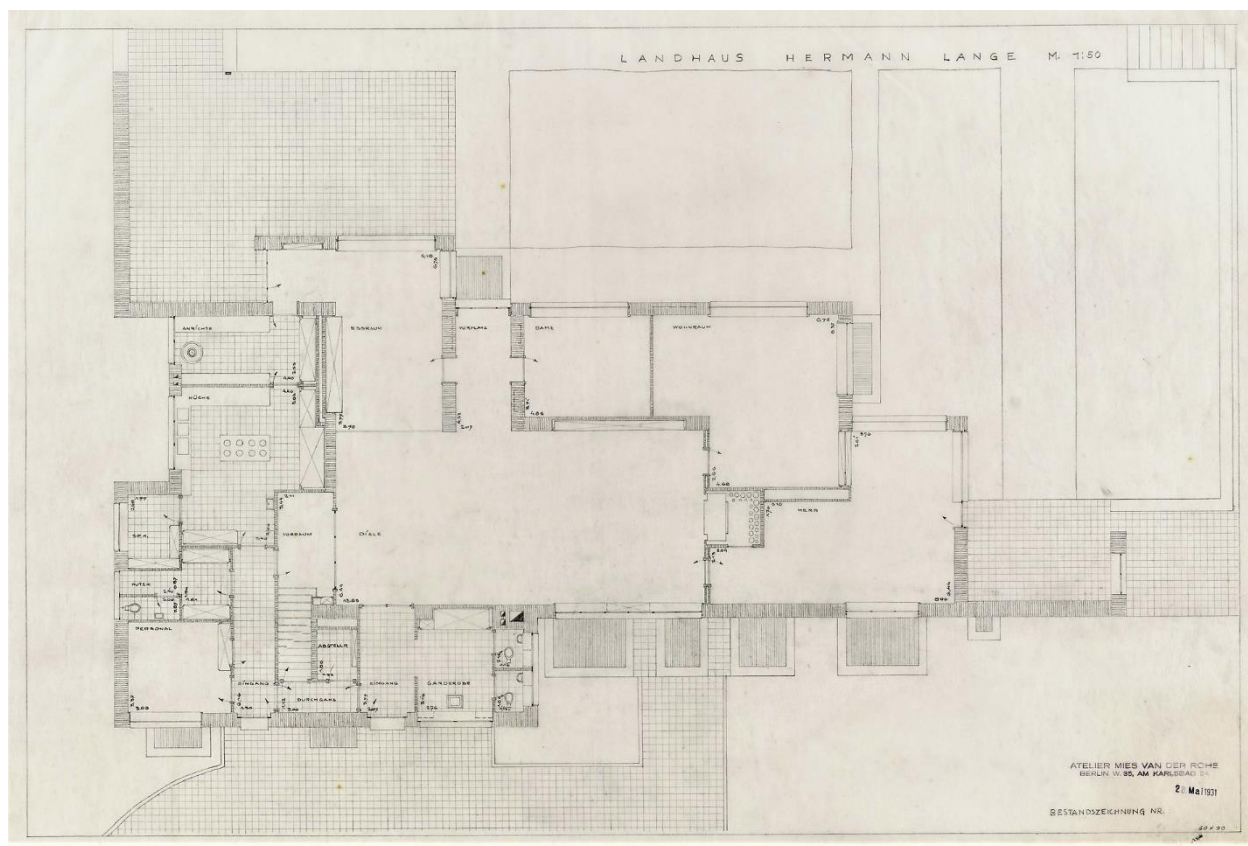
Planta piso de entrada da Casa Lange, 1927-1930.
